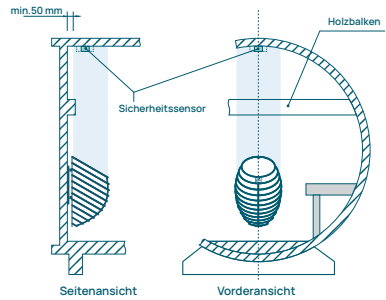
Installation des Sicherheitssensors an der Decke in Fasssaunen: wandmontierter Saunaofen
